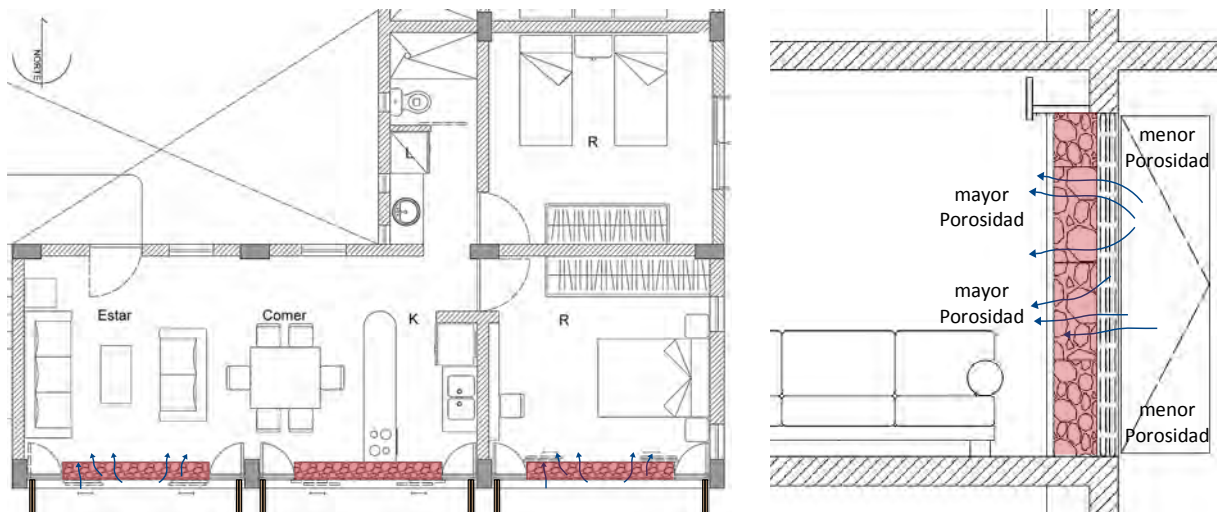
Planta y corte de integración de envolvente de gaviones a edificio existente. Los gaviones pueden sustituir en parte al sistema perimetral de muros, quedando entre la estructura principal y definiendo zonas estratégicas de ventilación, por ejemplo a la altura de los ocupantes. (Elaboración propia)
